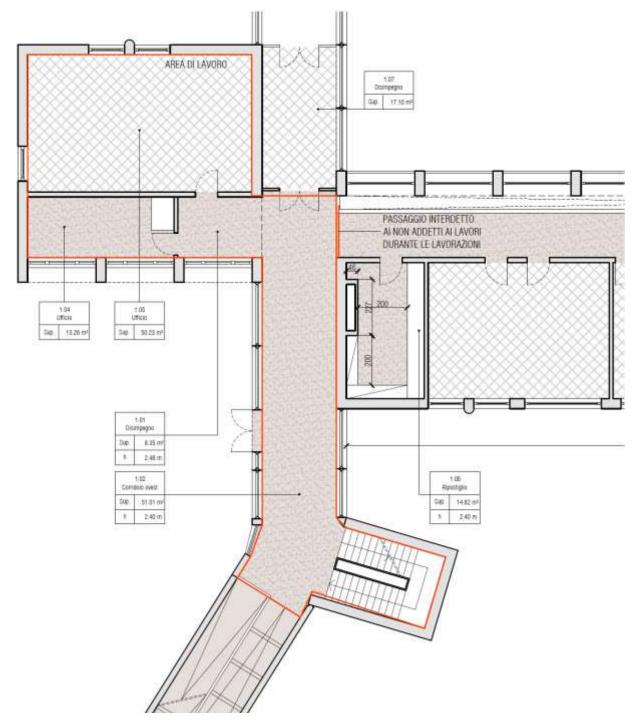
Particolare area di cantiere lotto 1 - piano primo
